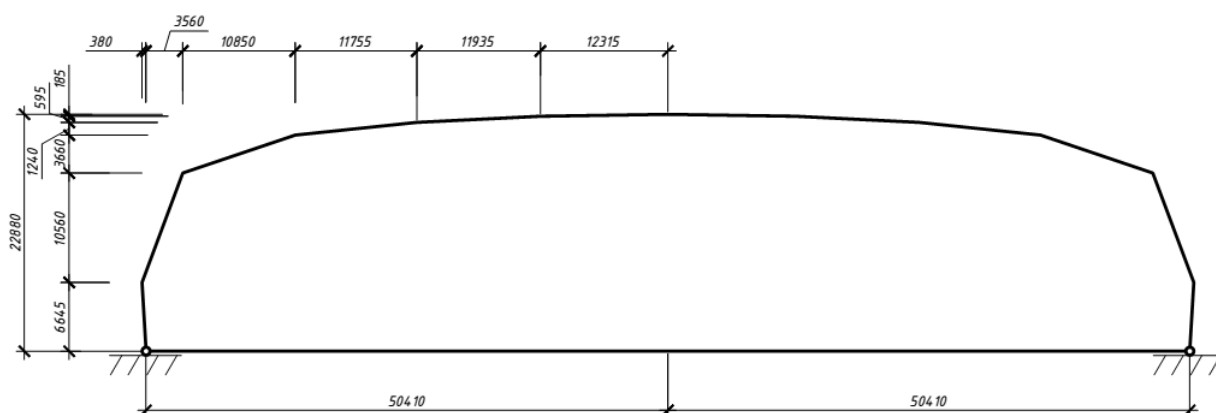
Предварительная расчетная схема поперечной рамы
